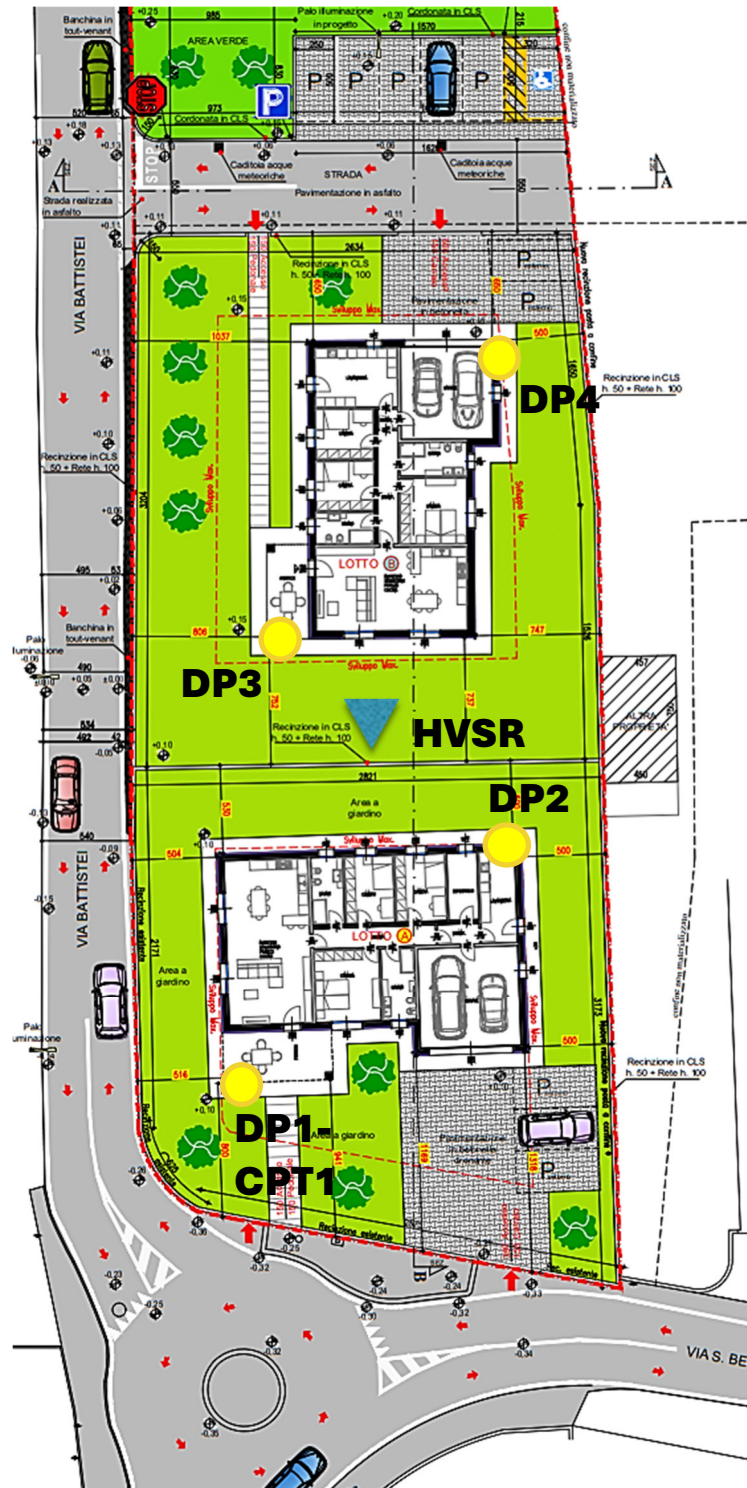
planimetria dell'intervento con ubicazione prove in sito
